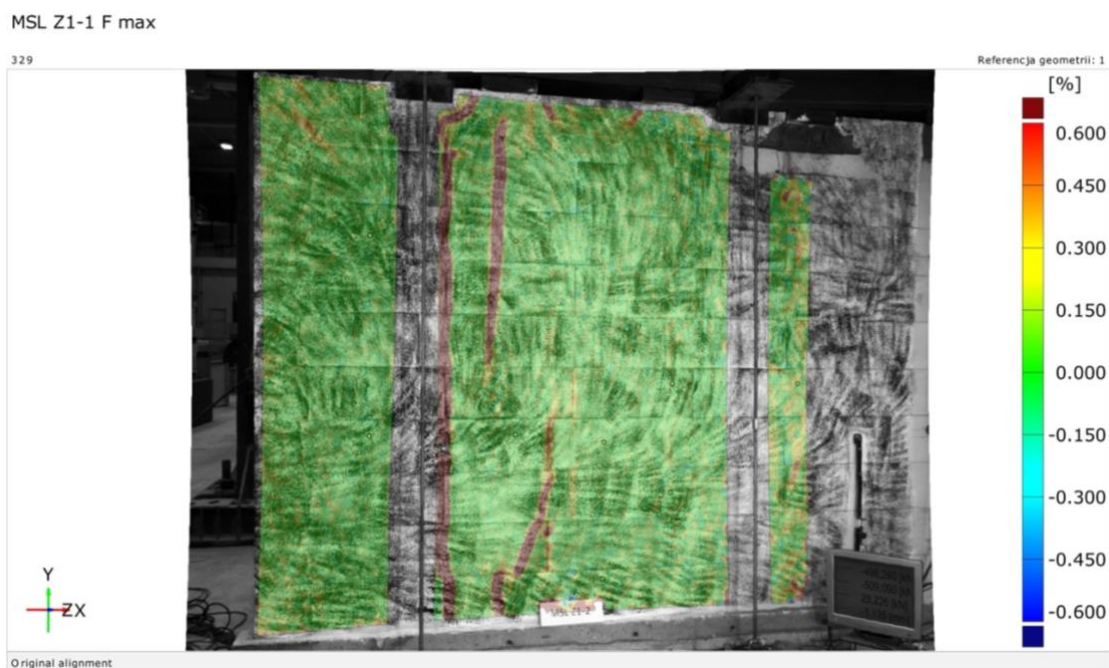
Uszkodzenia muru skrępowanego betonem lekkim
